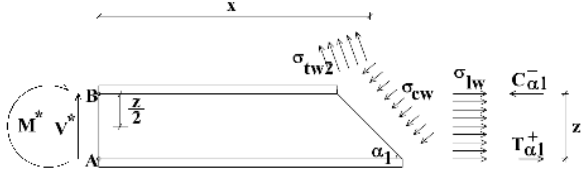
Tronco di trave, sezionato all'estremità con piano parallelo alla direzione delle staffe α_1
